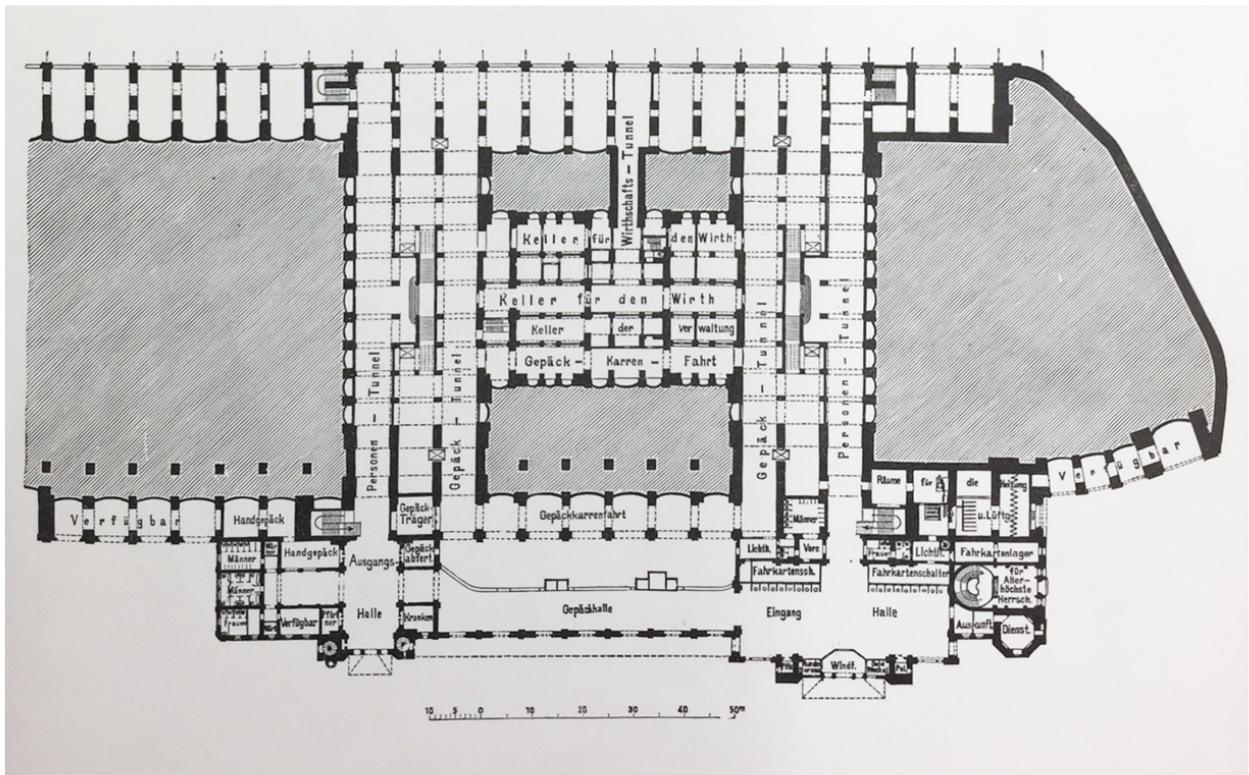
Köln Hbf 1894. Grundriß in Straßenhöhe
